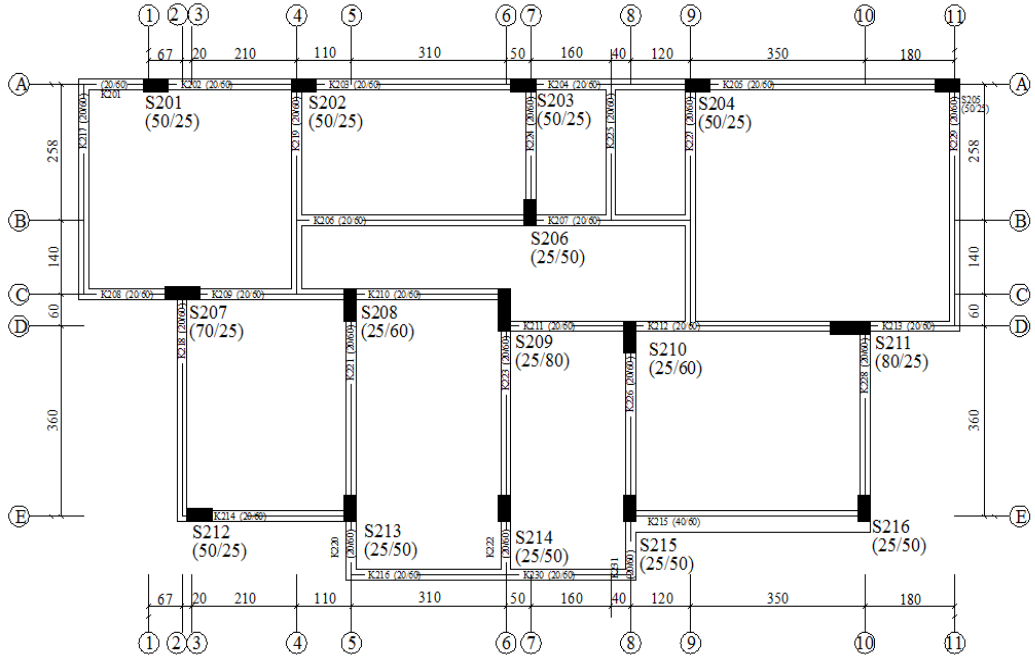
4K-B9 nolu binanın kalıp planı
